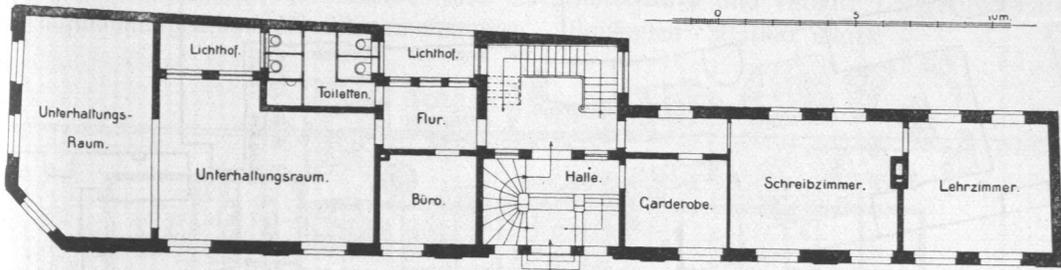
Martha-Helene-Heim, Erdgeschoß, Grundriß.
